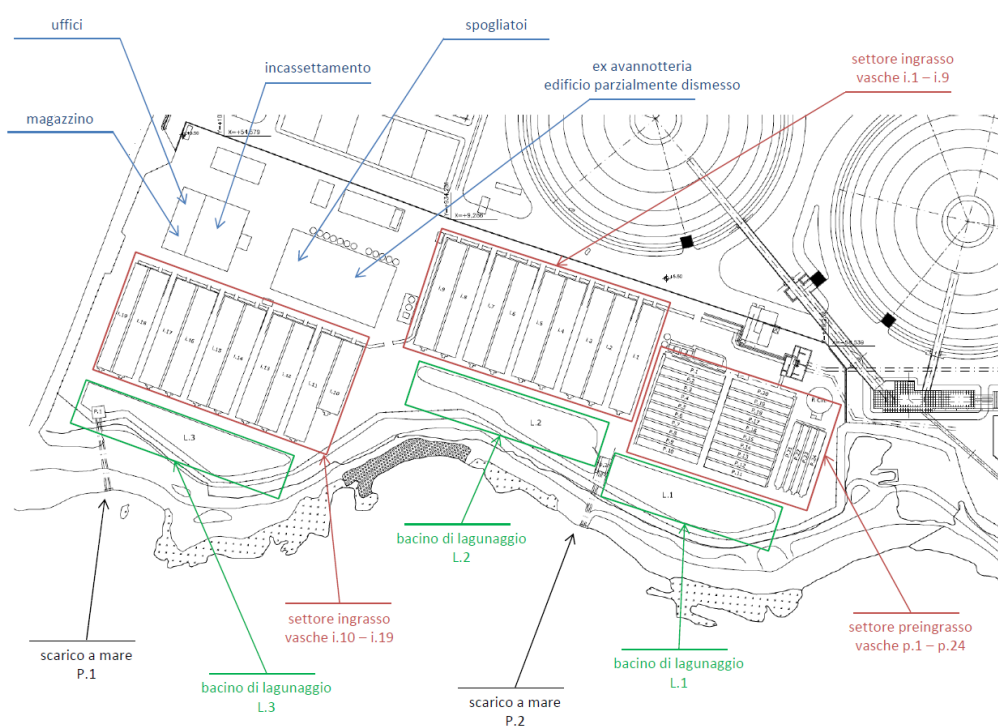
Planimetria e indicazione degli spazi dell'impianto a terra esistente
